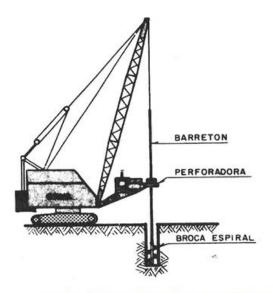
, Equipo de Perforación Montado en Grúa.
